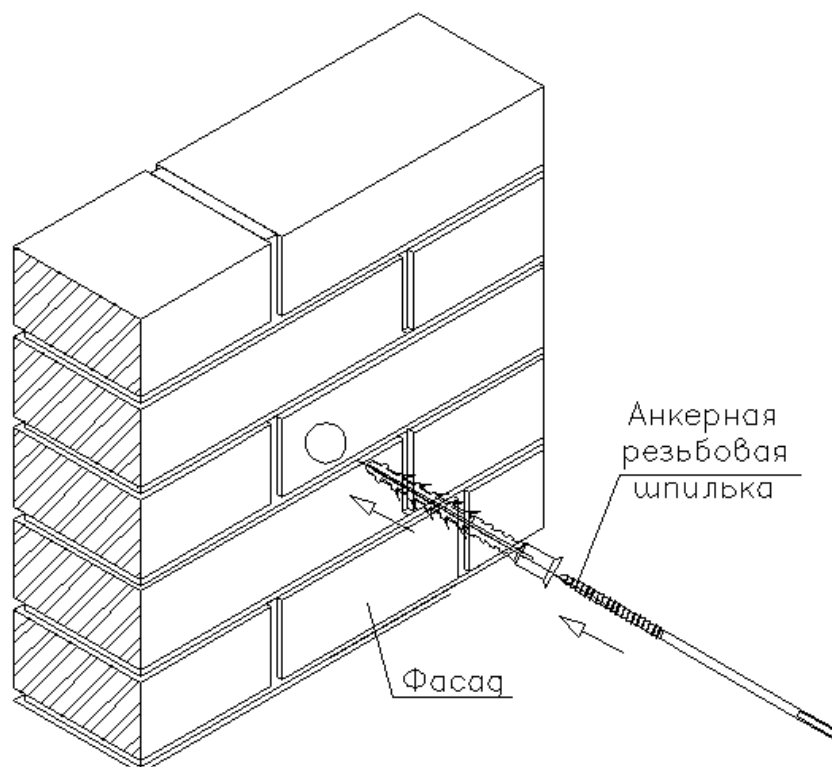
Установка анкерной резьбовой шпильки
